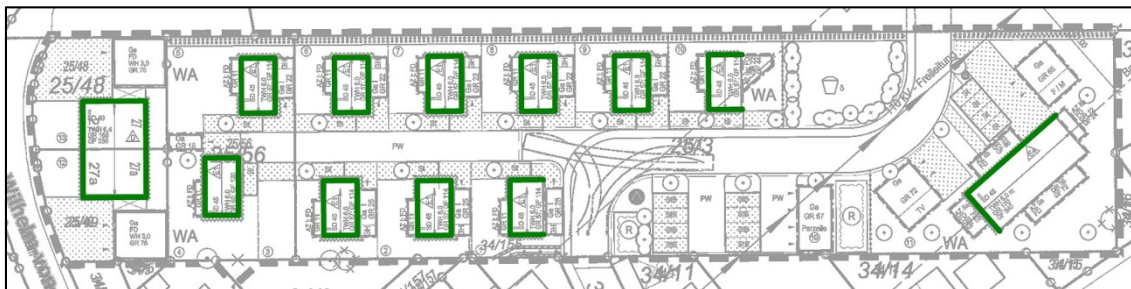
Lageplan mit Kennzeichnung der Fassaden, an denen Schallschutzmaßnahmen im Erd- und Obergeschoss erforderlich sind
